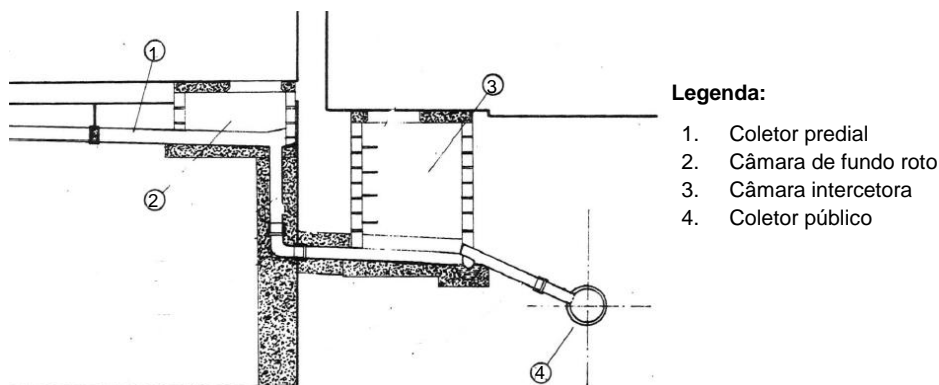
Câmara de fundo roto. Adaptado de (Ribeiro & Gaspar, 1970).
